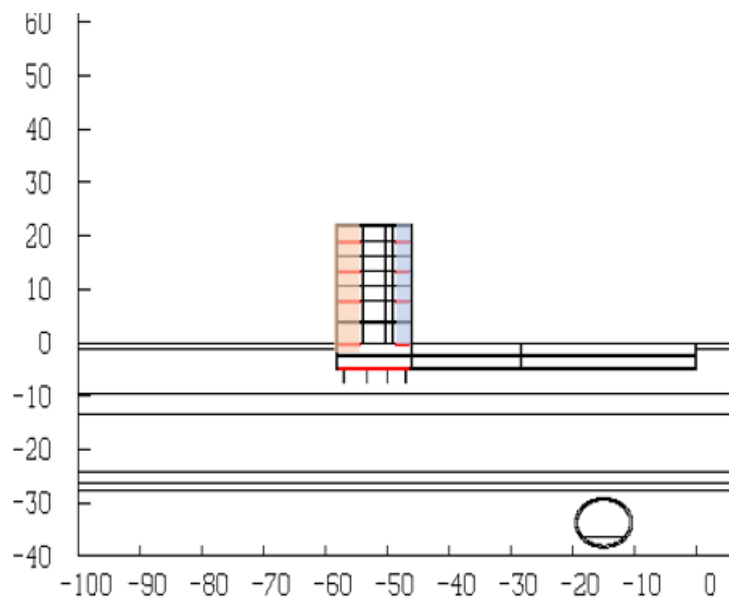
Bâtiment central : 4 murs de 10 cm pour 12,4 m (taux : 3.22%)
